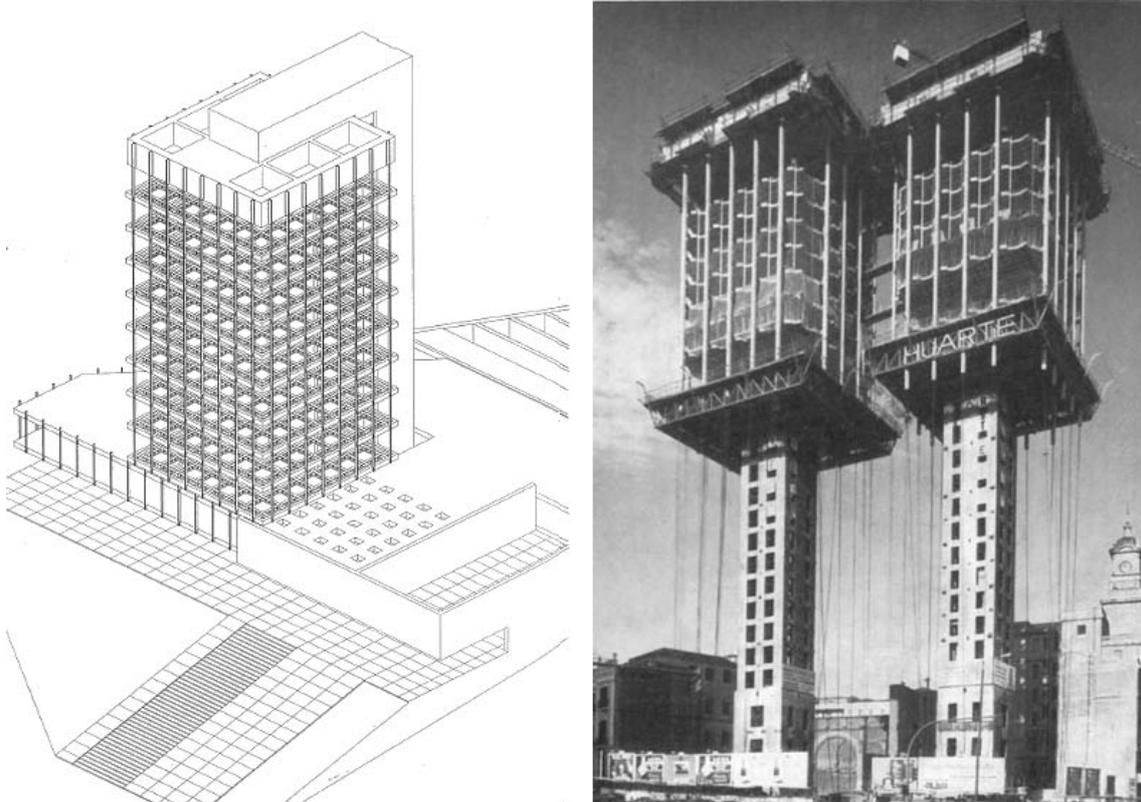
Esquema de la estructura del edificio Castelar – Torres de Colón en construcción.
